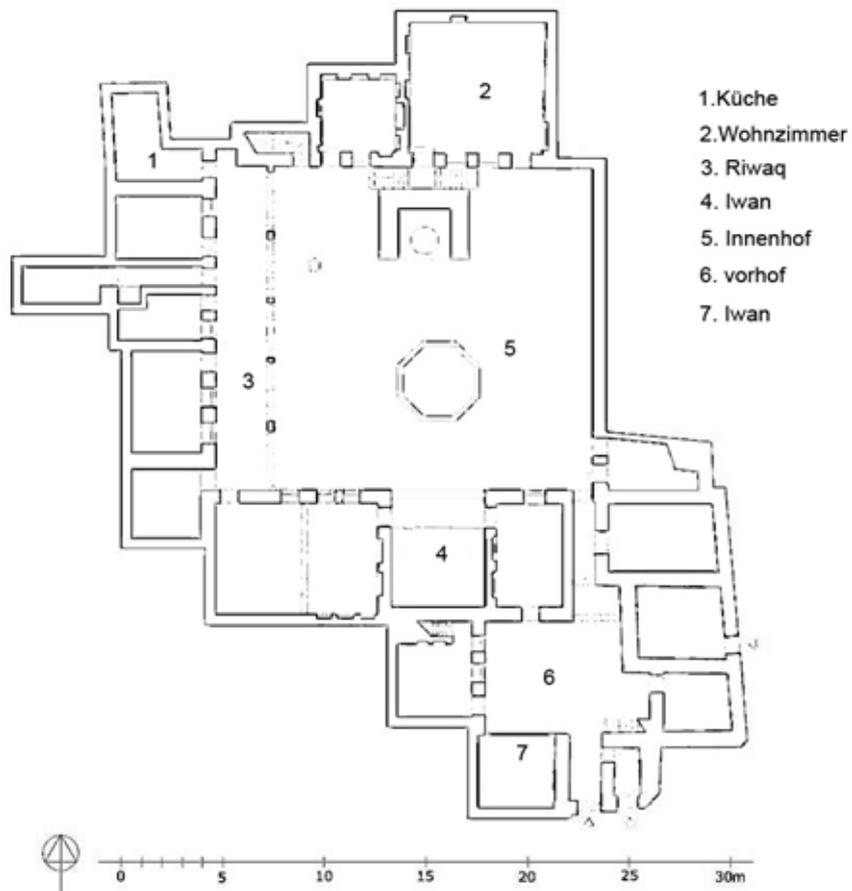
Bayt Saqqa`-Amini, Grundriss EG
